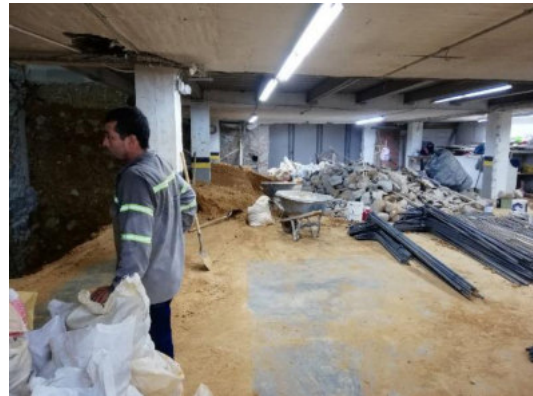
Fotografía almacenamiento de material y obras ejecutadas.
